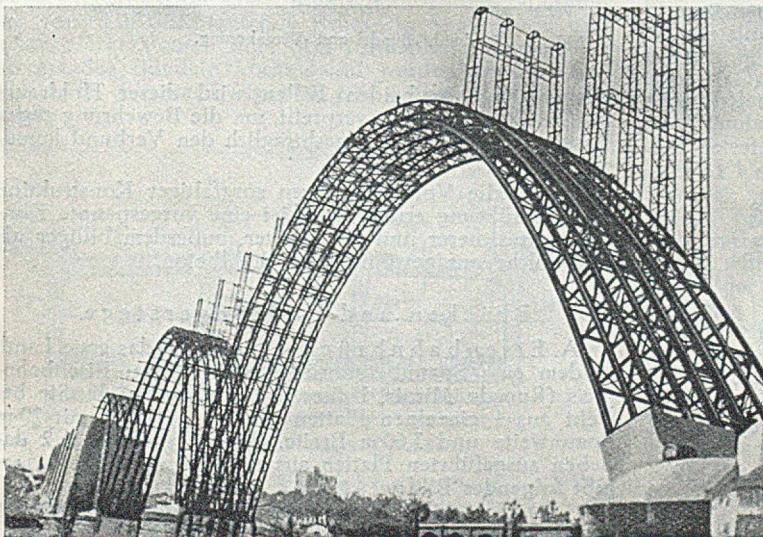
Stählernes Lehrgerüst der Eisenbahnbrücke über den Miñofluß in Spanien. Das Gerüst wird einbetoniert.
